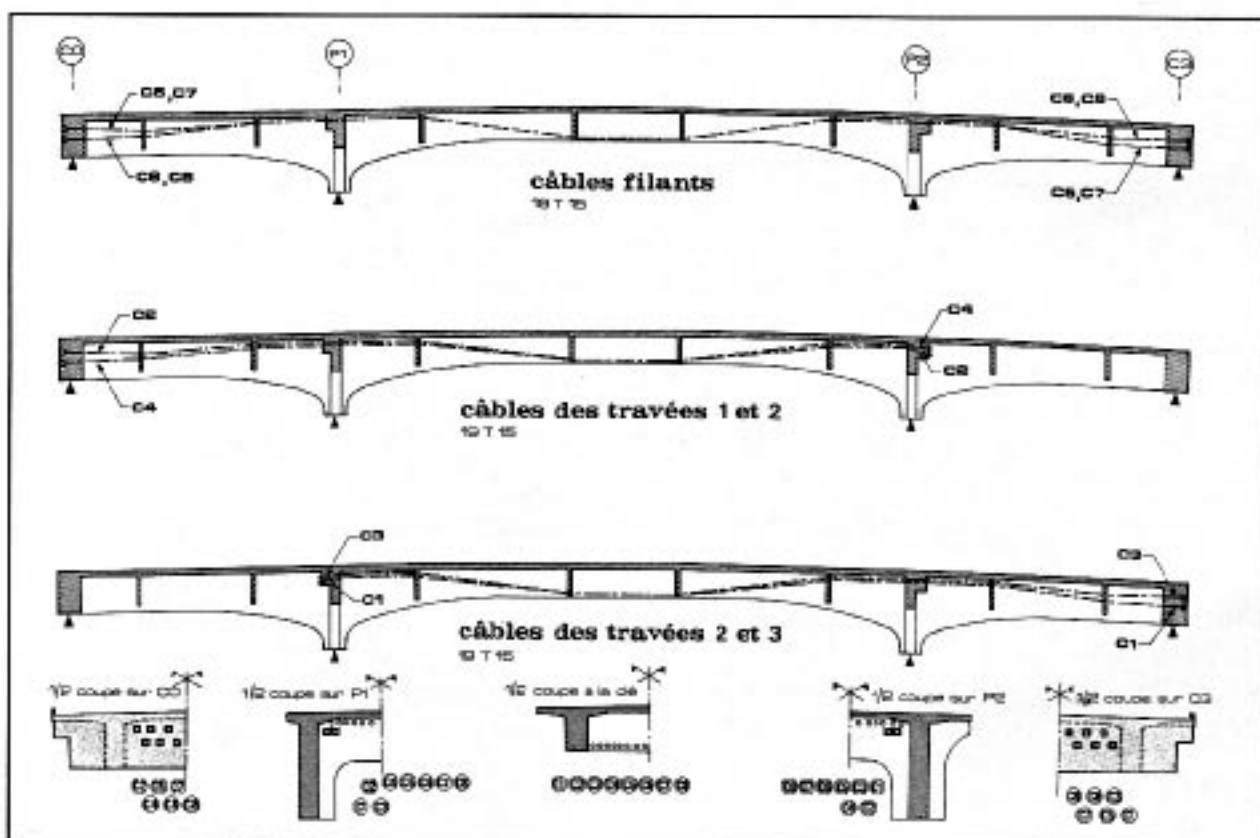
Schéma de câblage de l'ouvrage de la RN 79
